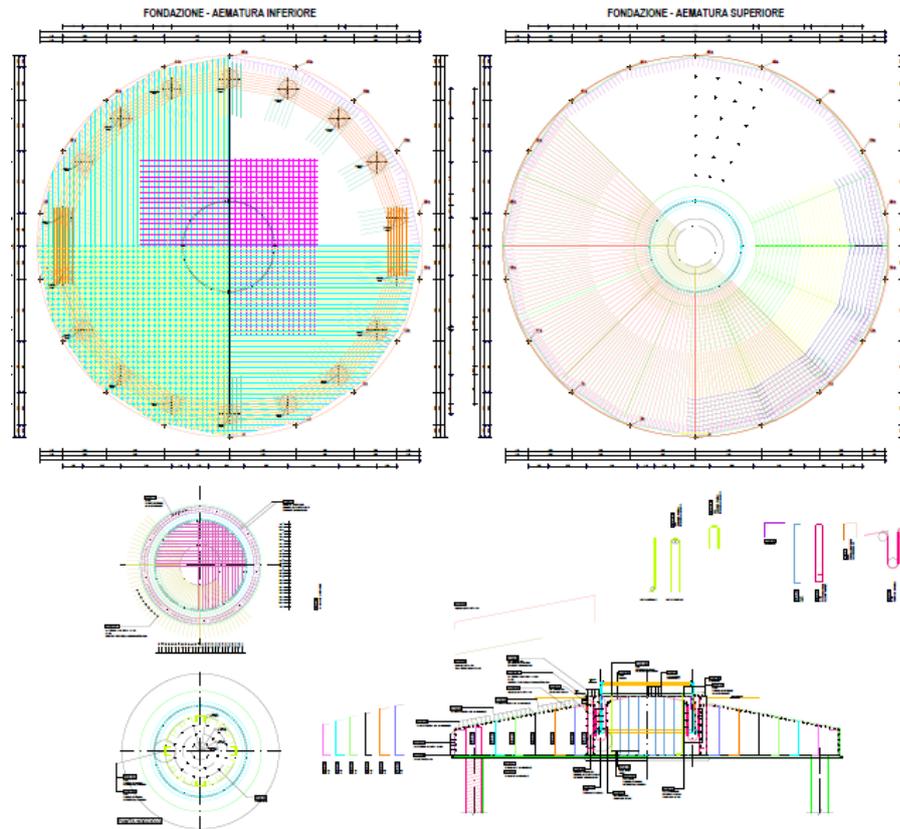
Pianta-sezioni e armature del plinto di fondazione
